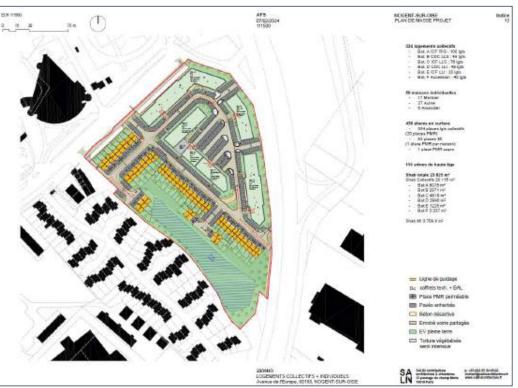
Plan de masse du projet (source: SALIN Architecture)
